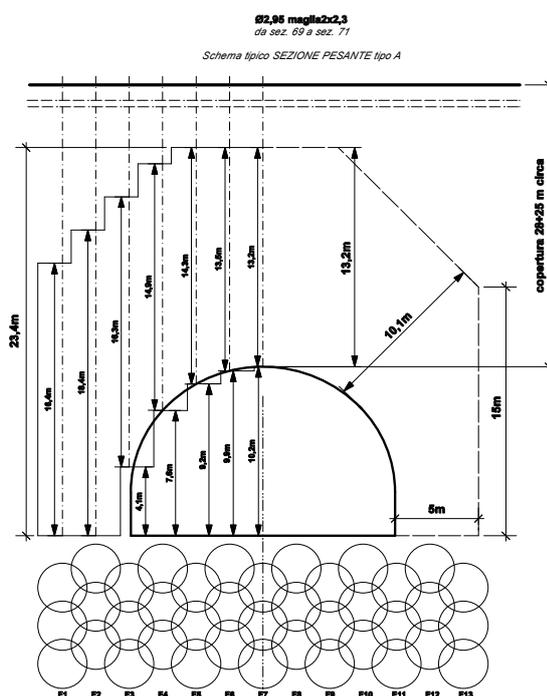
Schema del consolidamento dall'esterno in JET GROUTING per il superamento del fornello.
